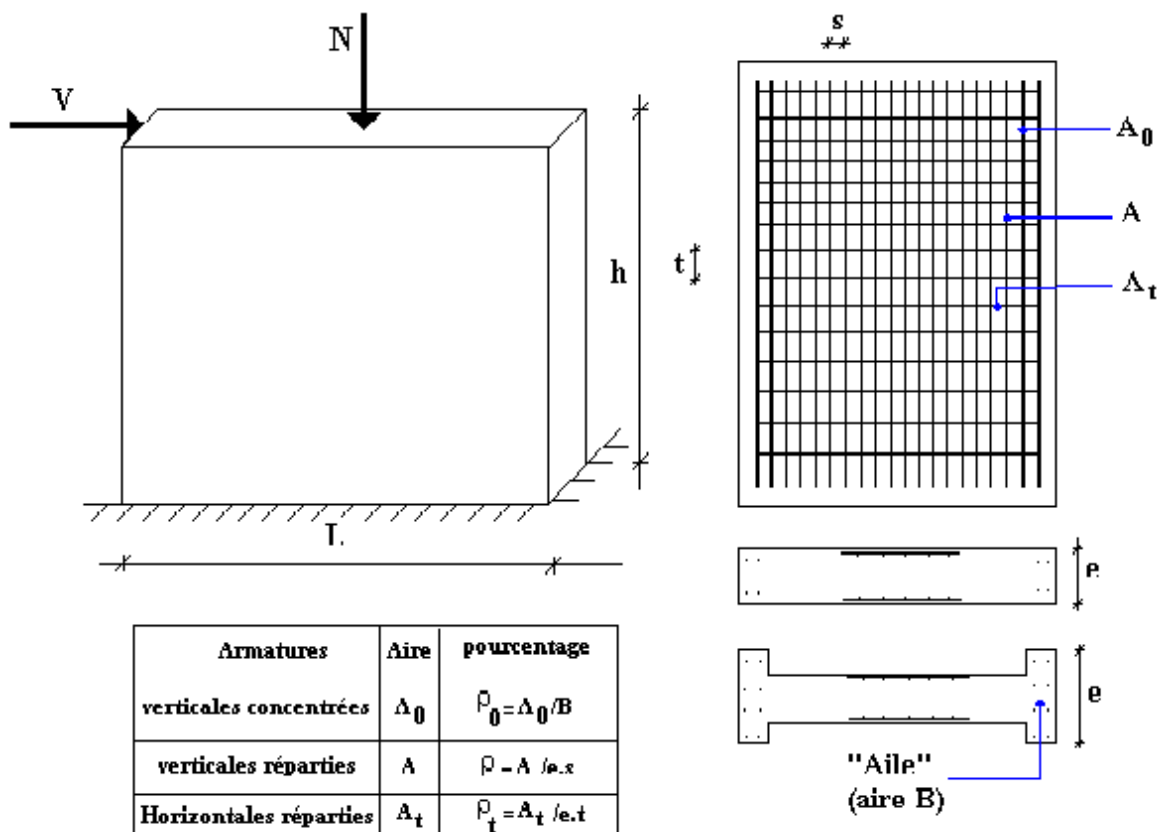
Schéma d'un voile plein et disposition du ferrailage.
